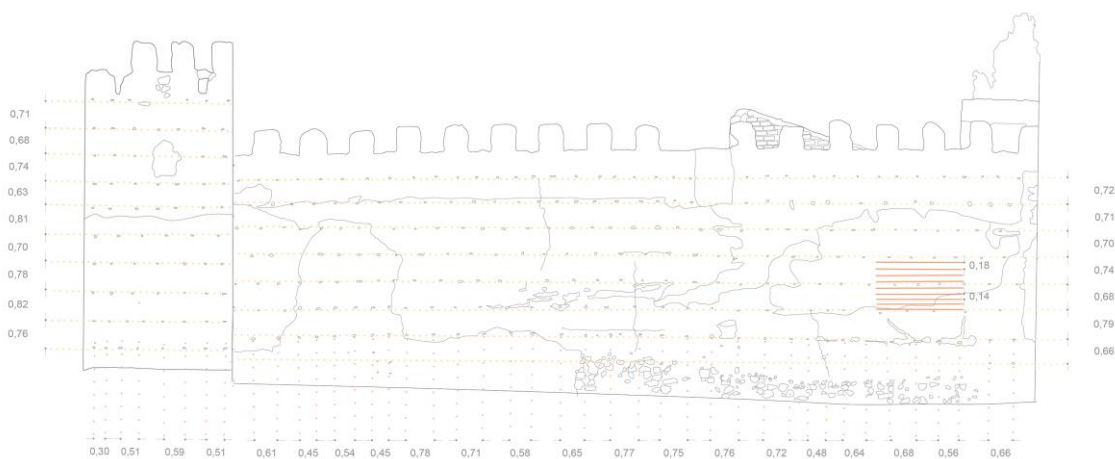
Esquema acotado de la construcción de la tapia en torre A y lienzo 1. Fuente: Autora.
